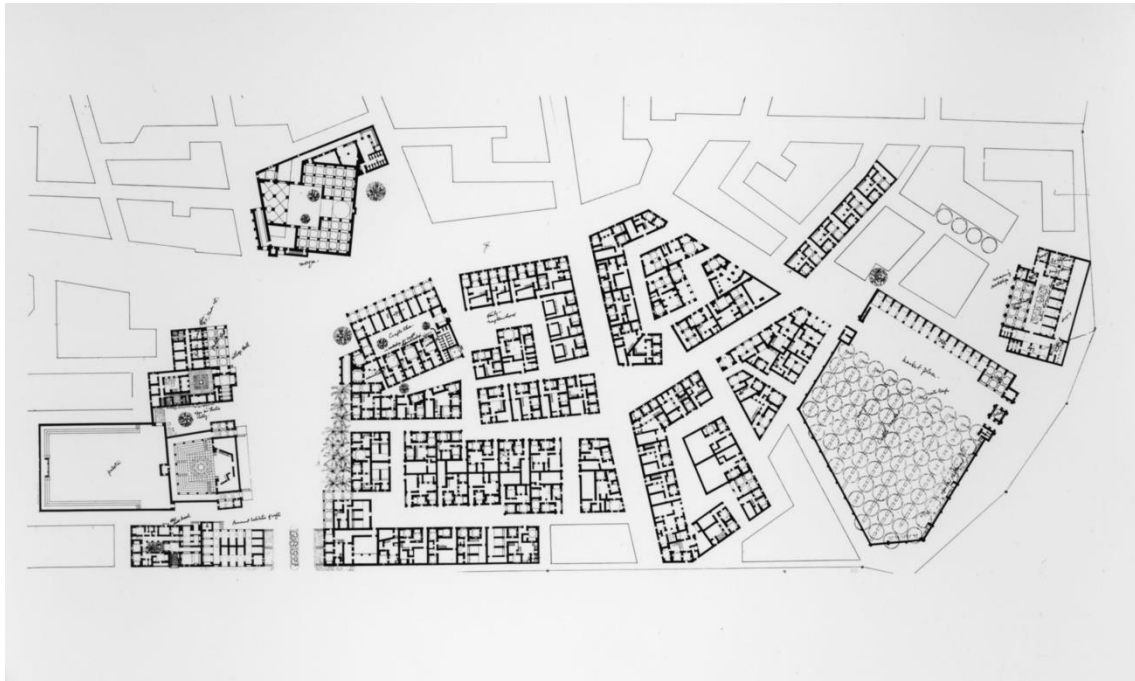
Planta Arquitectónica Proyecto de Nuev Gurna, Hassan Fathy. (MIT Libraries DOME, 1945-1948)
